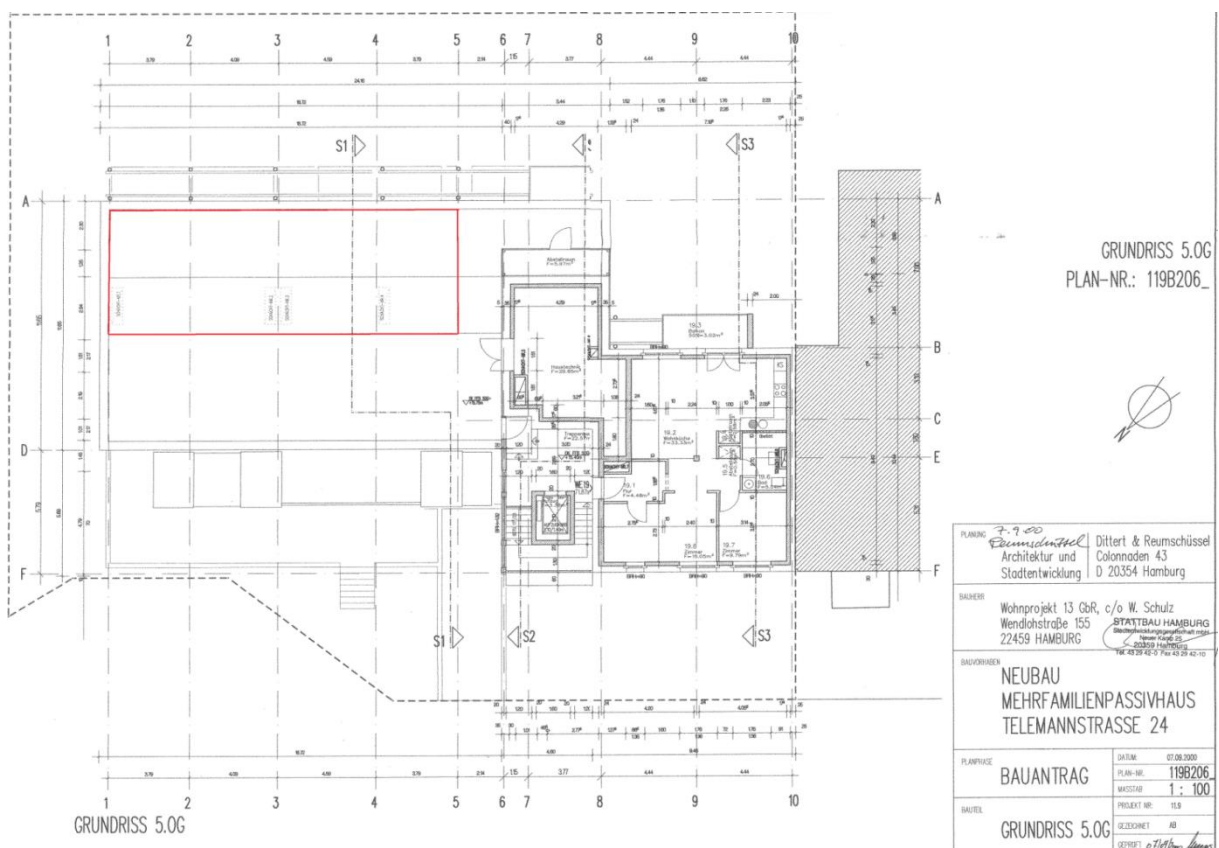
Rot eingerahmte Belegungsfläche auf dem Dach in dem Grundriss des 5.OG
